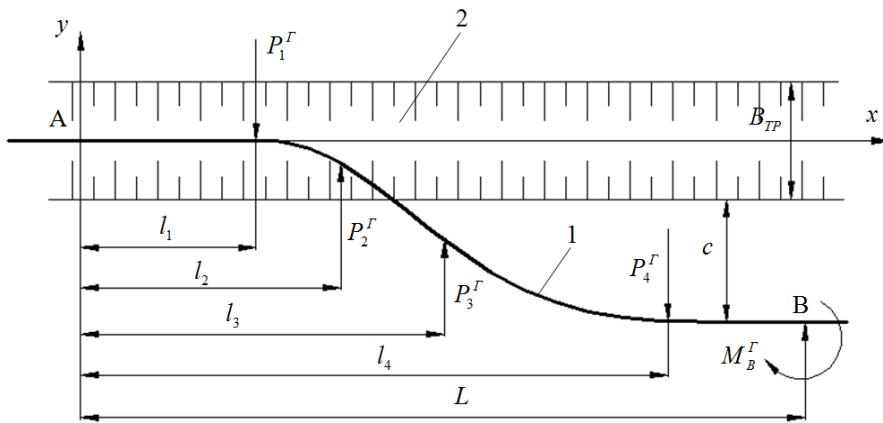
Розрахункова схема згину трубопроводу у горизонтальній площині: 1 – трубопровід; 2 – траншея
